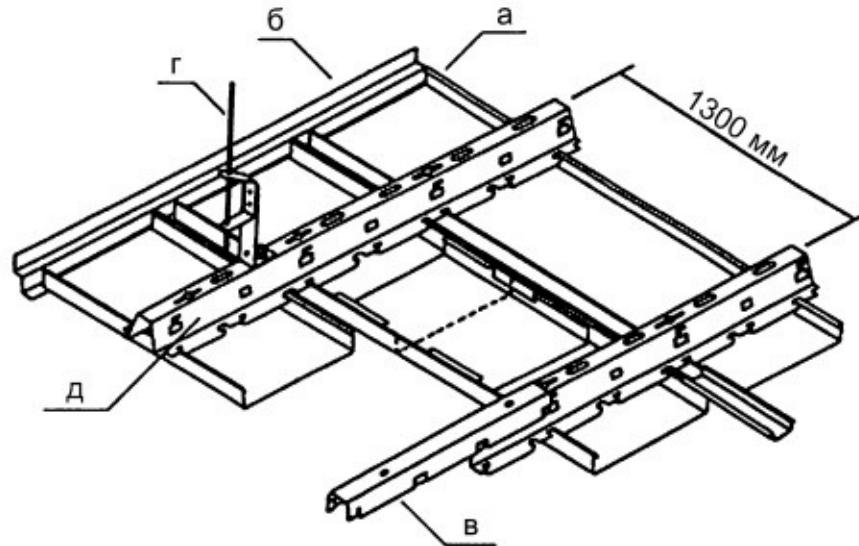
Схема обшивки потолка гипсокартоном: а — декоративная планка; б — пристенный кант; в — удлинитель направляющего профиля; г — подвес с тягой; д — направляющий профиль
